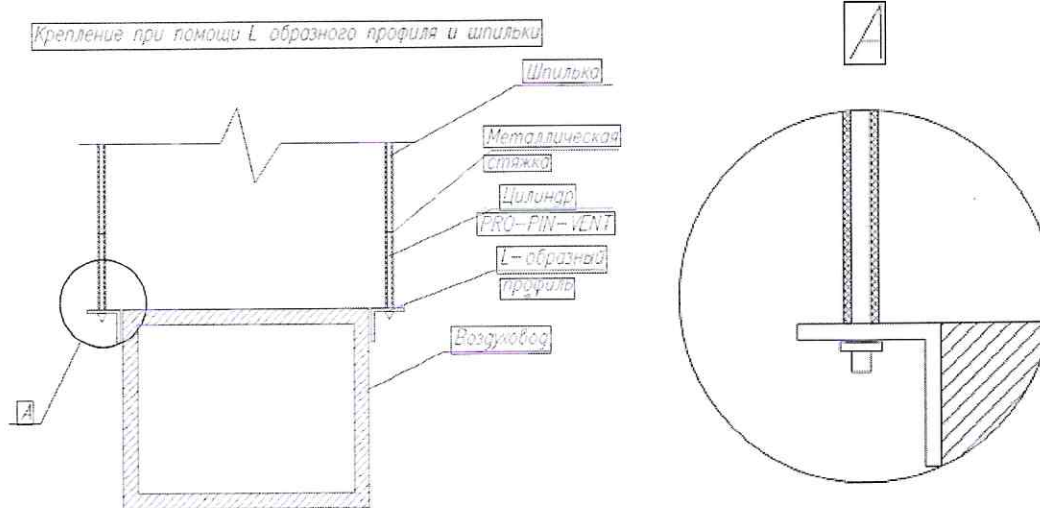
Огнезащита шпилек при креплении с помощью L-образного профиля
